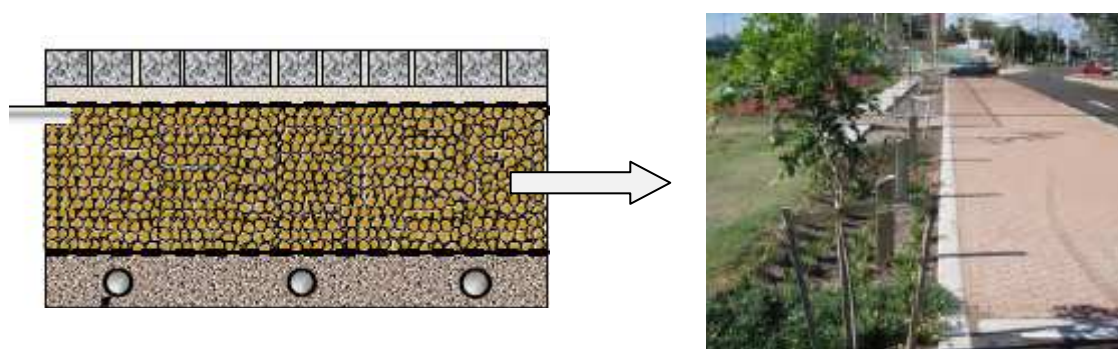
Esquema e foto da técnica de pavimento poroso em canteiros públicos.
